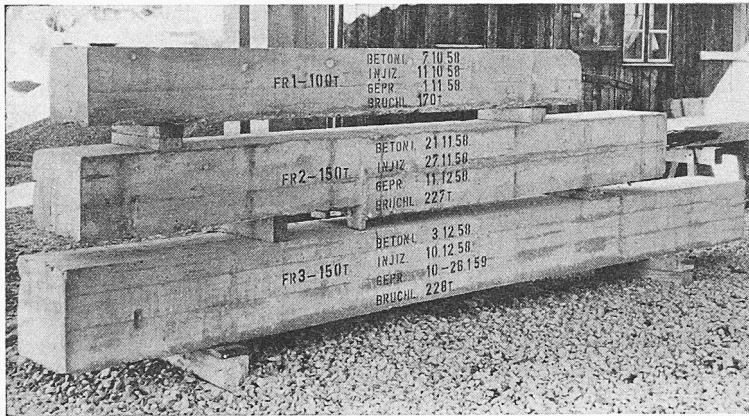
Betonkörper mit injizierter VSL-Felsankern nach dem Zerreißversuch
